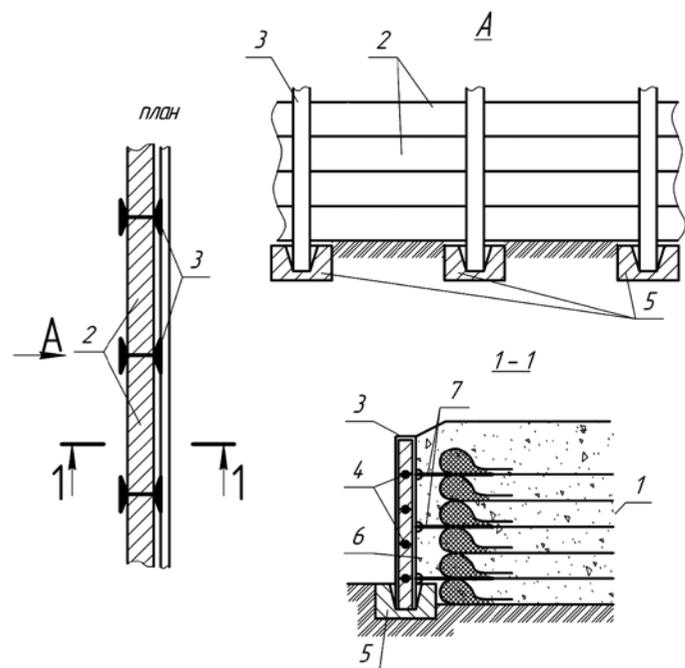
Армогрунтовая система из рулонных материалов; лицевая стенка, работающая независимо от армогрунтовой системы, выполнена в виде сборной конструкции:
